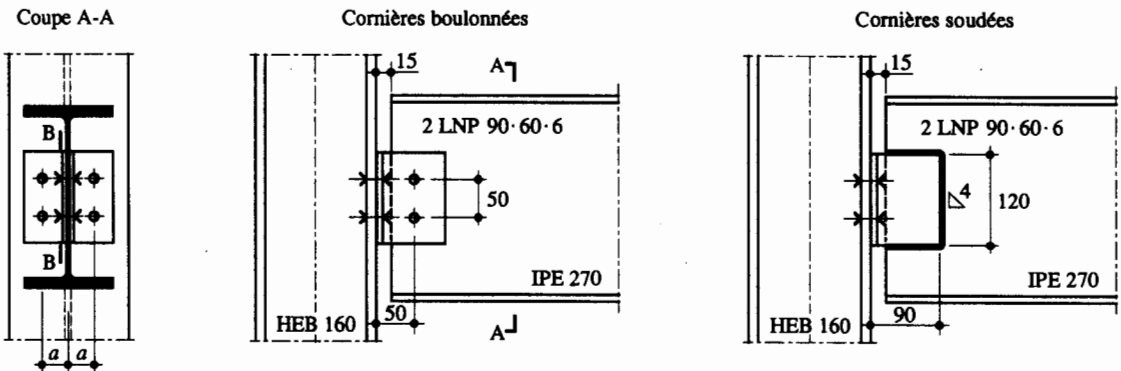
Liaison poutre-colonne avec doubles cornières.
